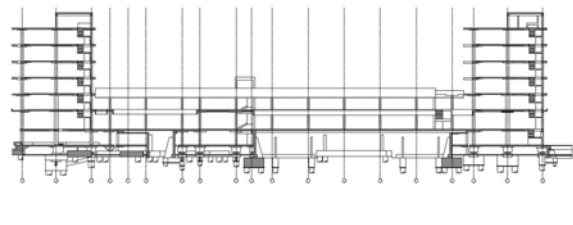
Sezione longitudinale dell'edificio residenziale per anziani.
